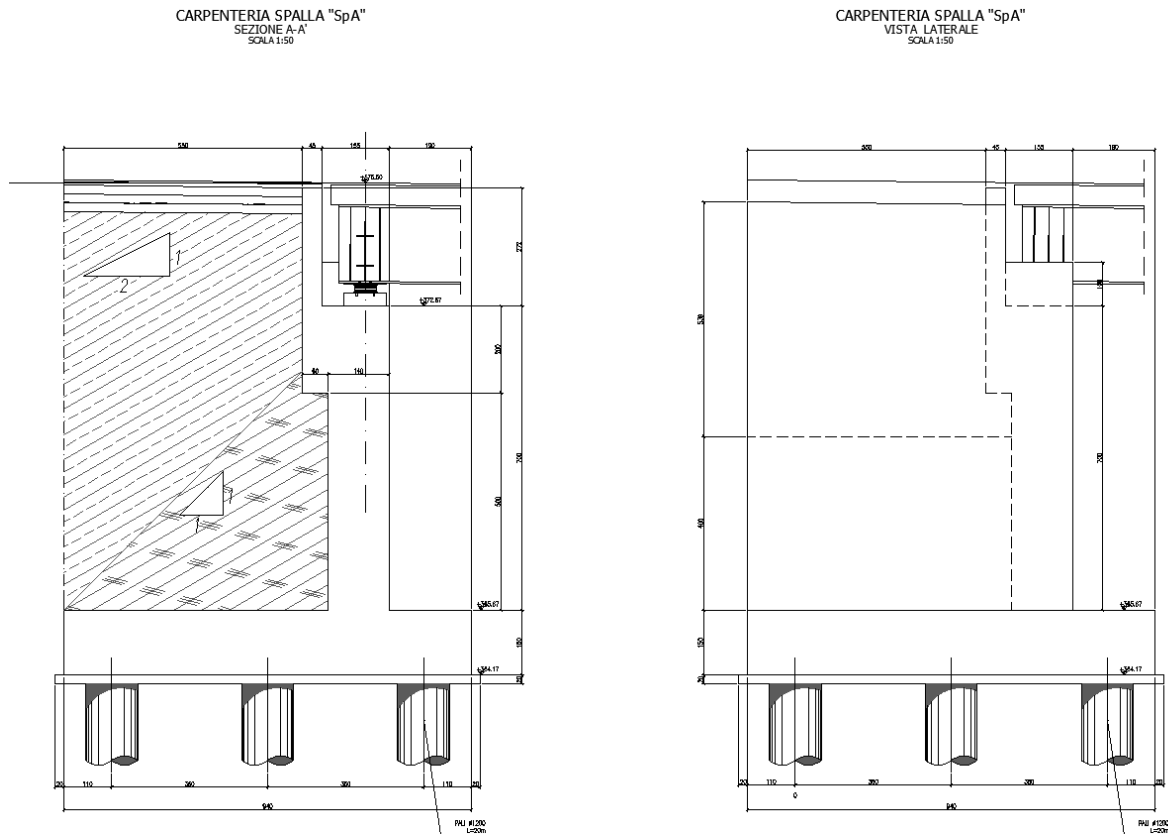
Sezione e vista longitudinale spalla A.
